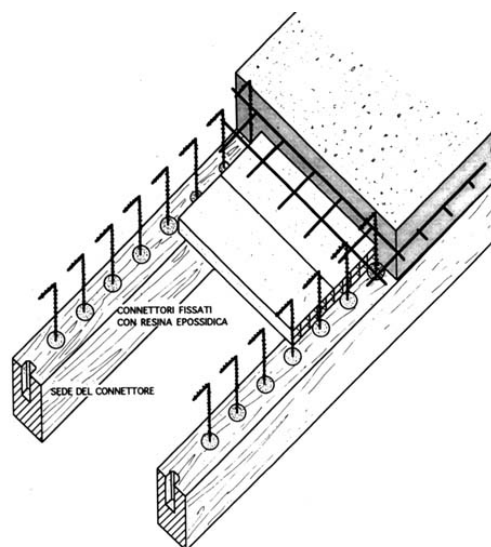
Turrini - Piazza (ref. 33)
